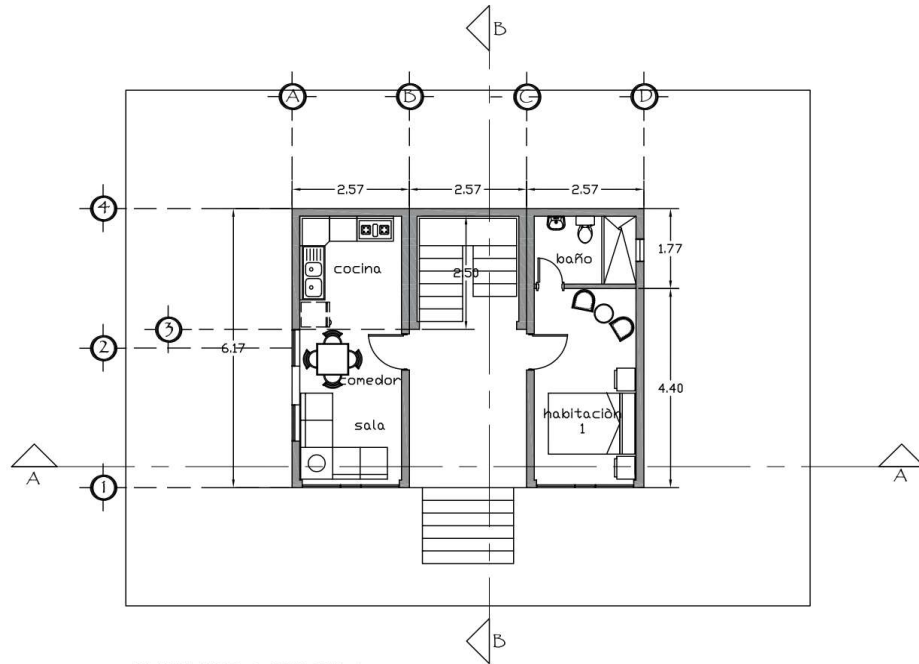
Planta Primer Nivel Tipología - A - Elaboración propia
